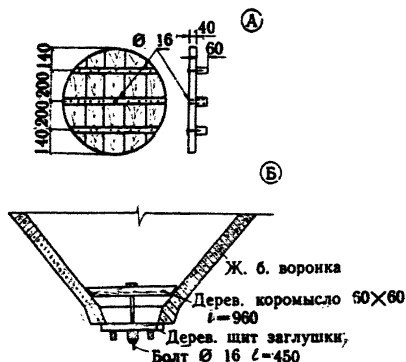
Инвентарное устройство для временного закрытия отверстий в воронках: А. — щит заглушки; Б. — крепление заглушки в воронке
